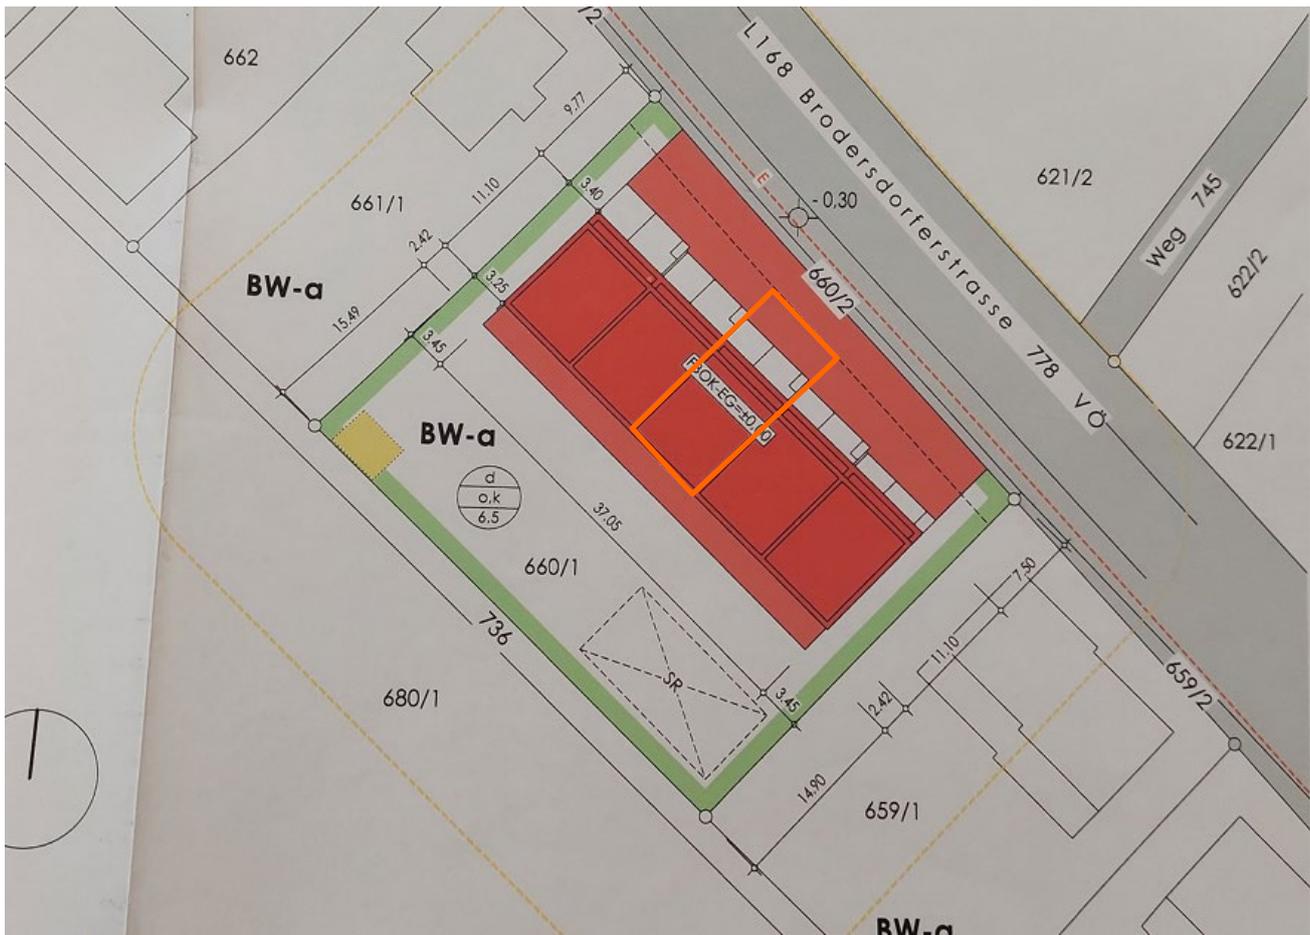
Lageplan – Verortung des Reihenhaus in der Reihenhausanlage | Einreichplan | 26.08.2014
